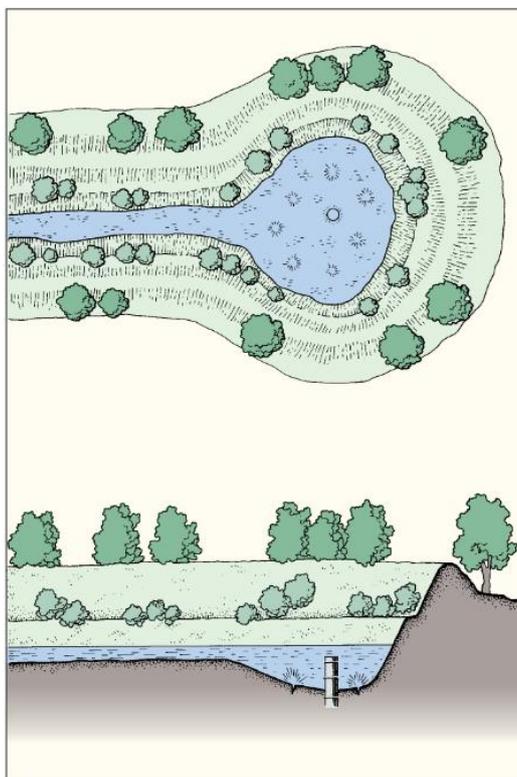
Sezione e pianta di un fontanile (fonte: AA. vv., 2001)
